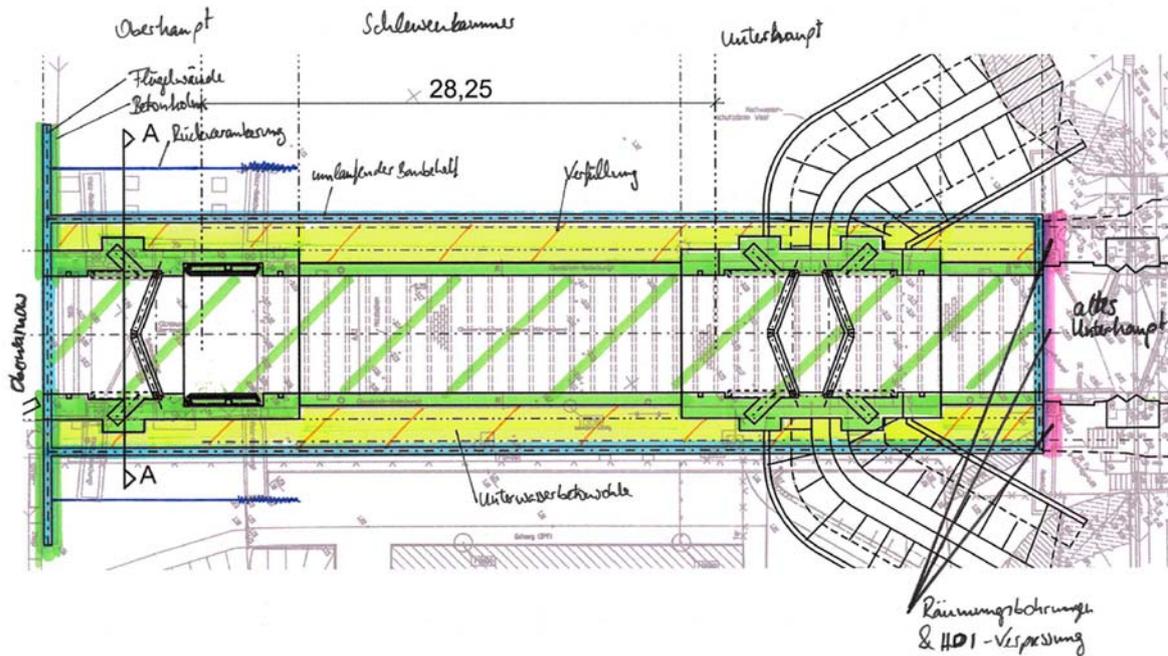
Variante 1 (Bestandssanierung mit Stahlbetontrog) – Bauzustand, Draufsicht
